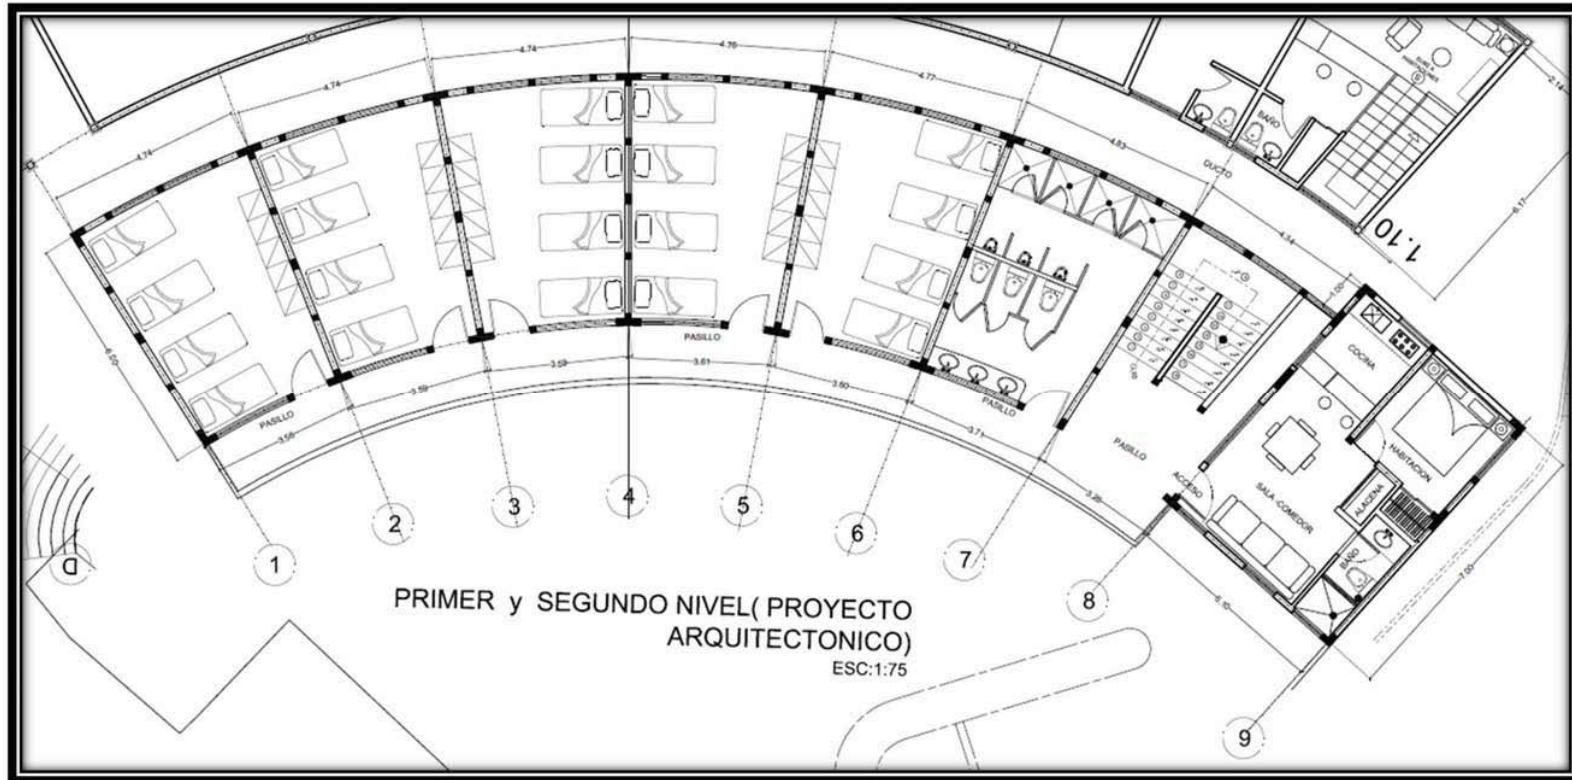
Planta arquitectónica del proyecto en construcción EDIFICIO-4. Planta tipo de habitaciones.
